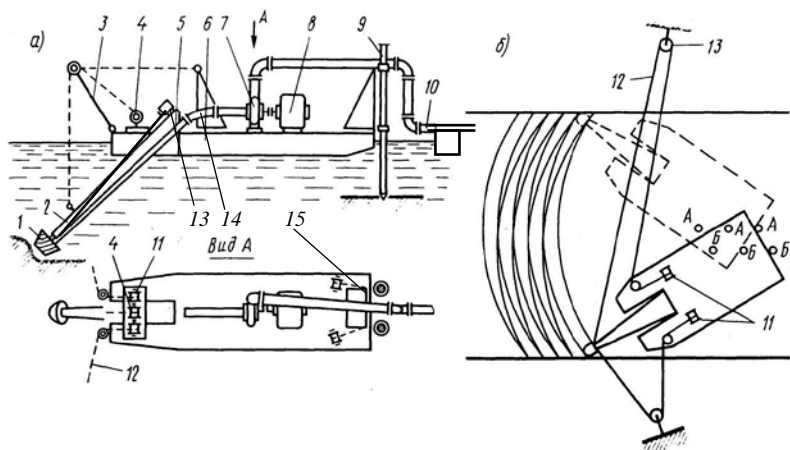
Схема земснаряда: а – вид сбоку и сверху; б – схема свайно-тросового папильонирования; 1 – рыхлящий орган; 2 – рама; 3 – стойка; 4, 11 – лебедки; 5 – всасывающий трубопровод; 6 – корпус; 7 – грунтовой насос; 8 – двигатель; 9 – сваи; 10 – пульпопровод; 12 – канаты; 13 – отводные блоки; 14 – гибкая вставка; 15 – лебедочный механизм
